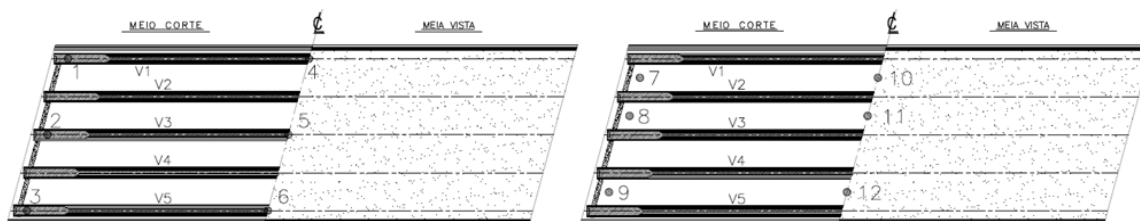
Pontos escolhidos para o dimensionamento das lajes das pontes em vigas múltiplas.
